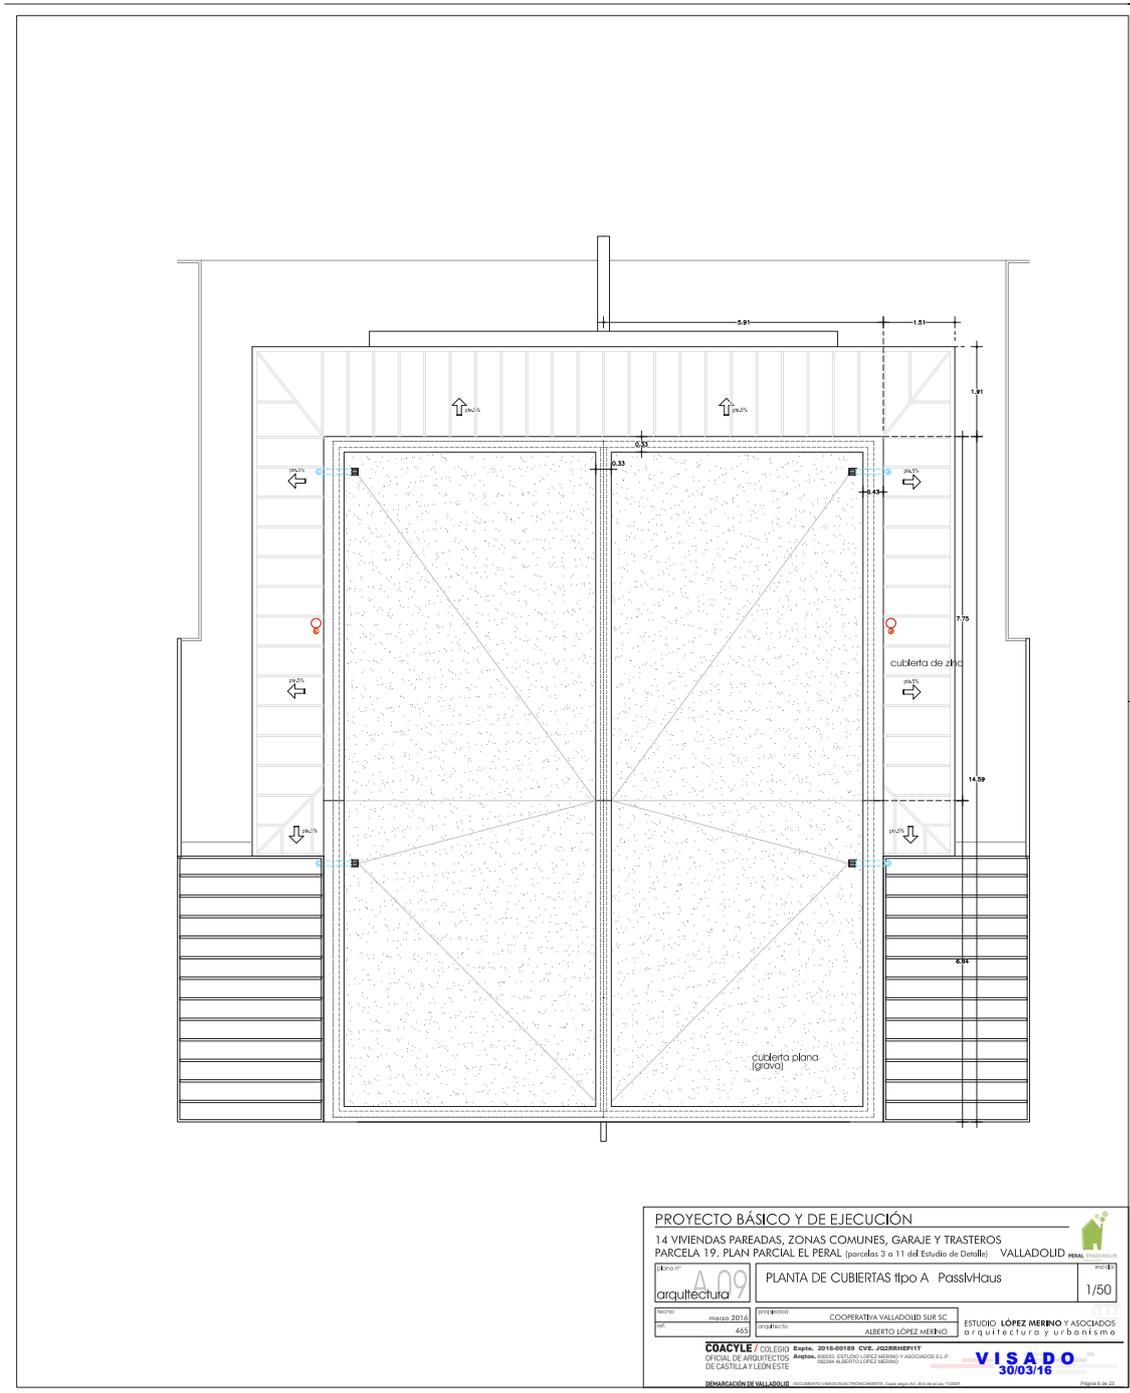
Planta cubierta. Fuente: Estudio López Merino
